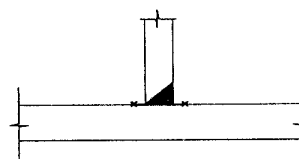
PLANOS DE CORTE EN SOLDADURAS DE FILETE
